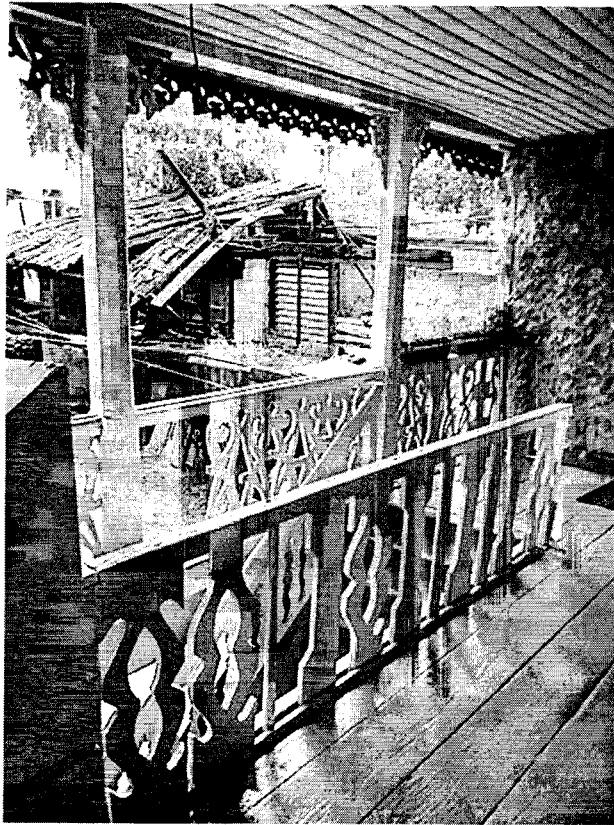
Фрагменты продольного, дворового (северо-восточного) фасада открытой галереи, 2-ой этаж. Ограждение балкона
